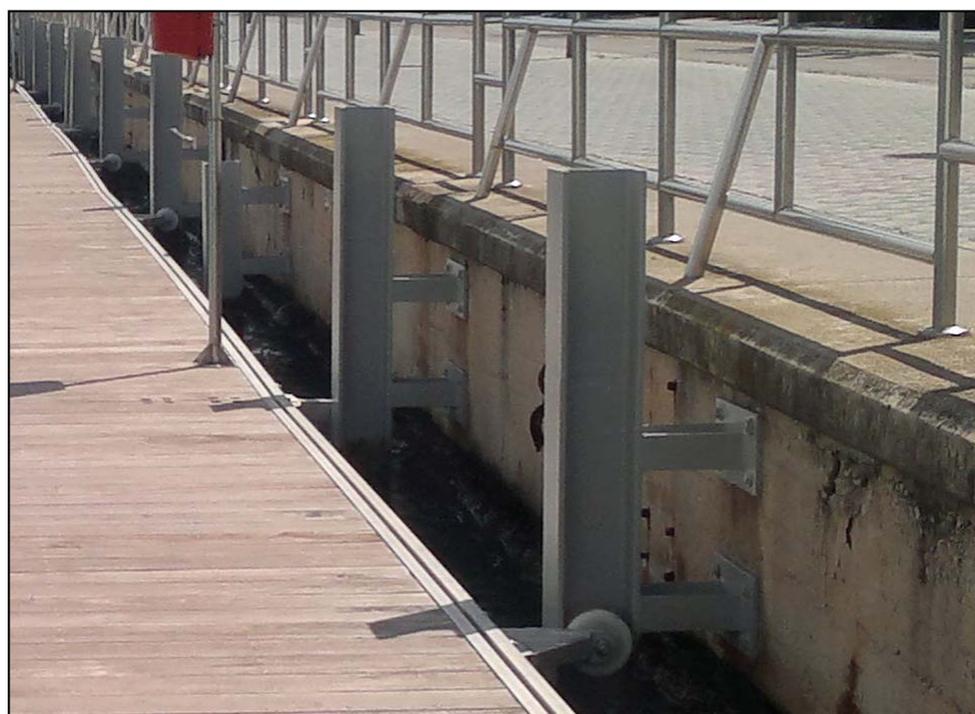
Vigas GREY instaladas en Pantalán Flotante
